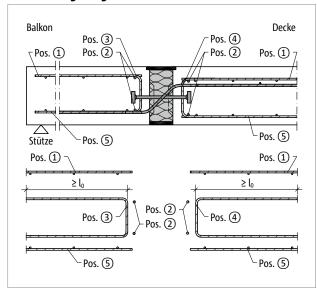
Schöck Isokorb® T Typ QP: Bauseitige Bewehrung
